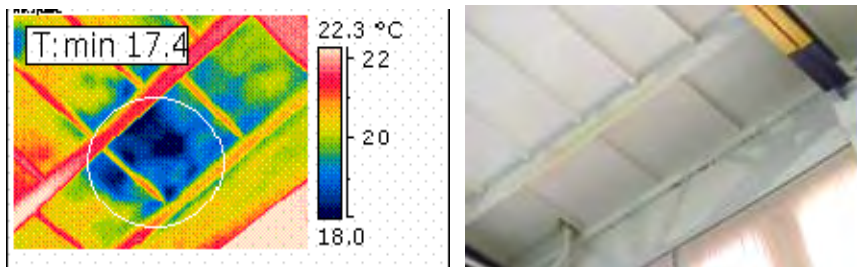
Тепловизионное и обычное изображение кровли с дефектом утепления
